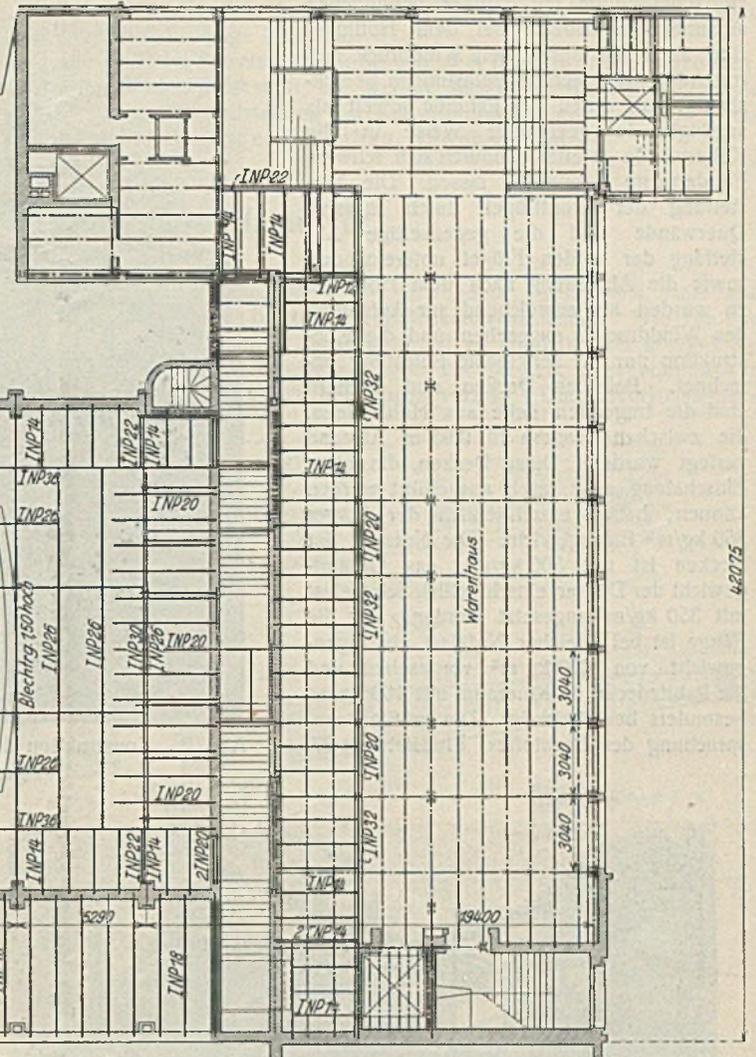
Grundriß. Erdgeschoß und 1. Obergeschoß.
